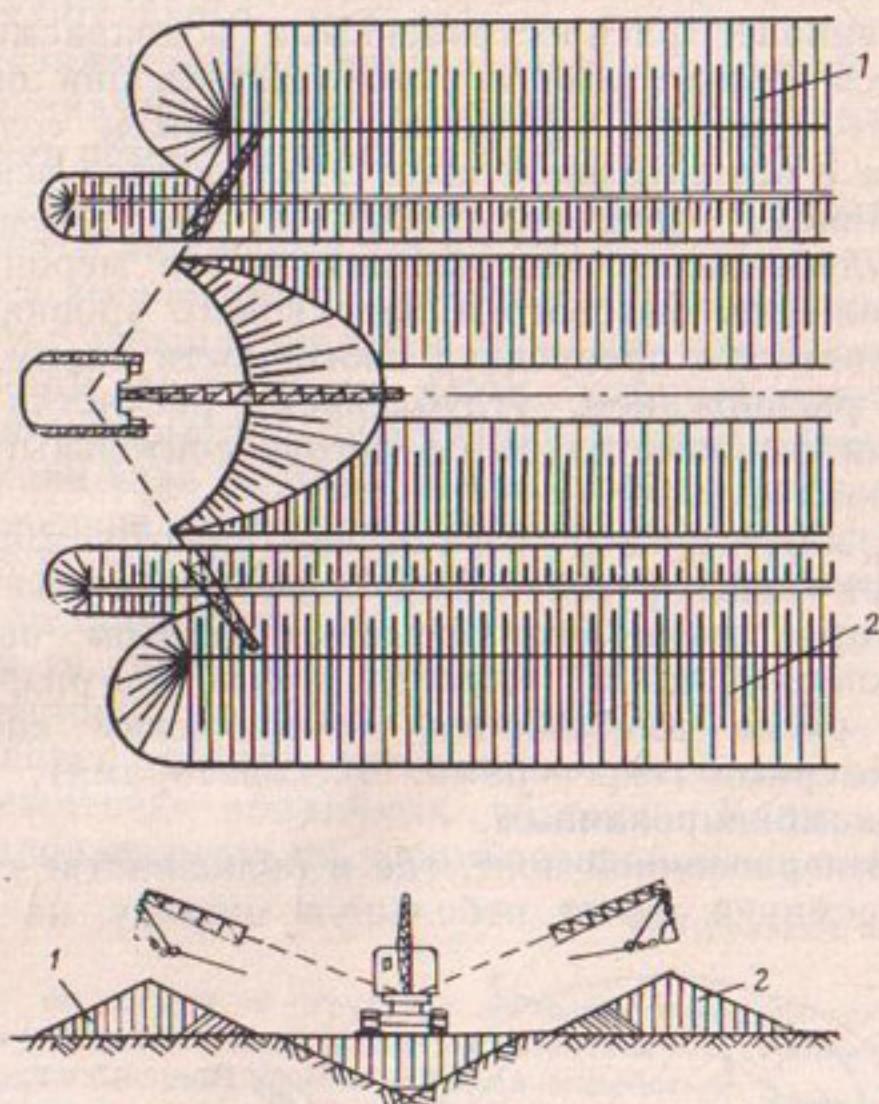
Продольная разработка с откидкой грунта на обе стороны:
